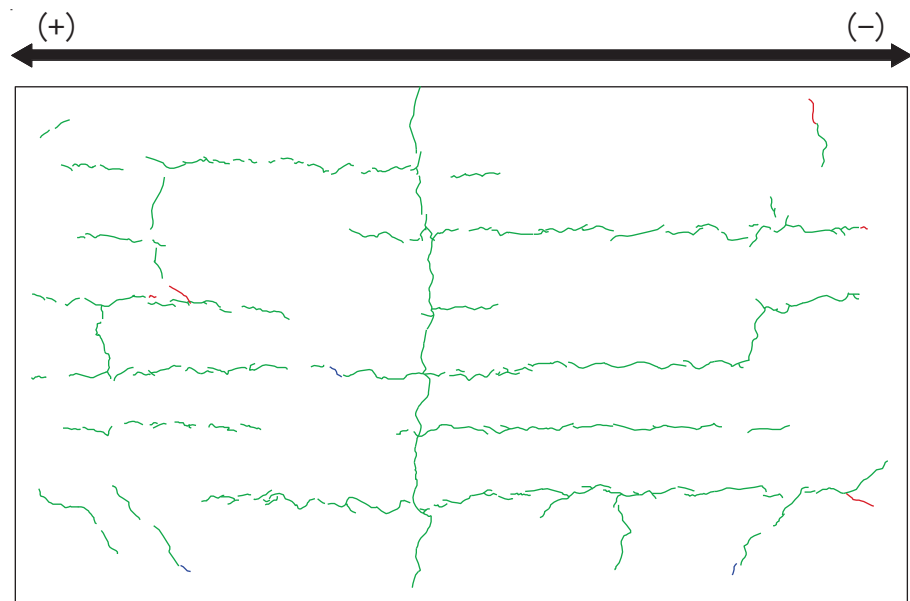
(2) 乾燥試験体 [1] 1/10000rad. におけるひび割れ図
